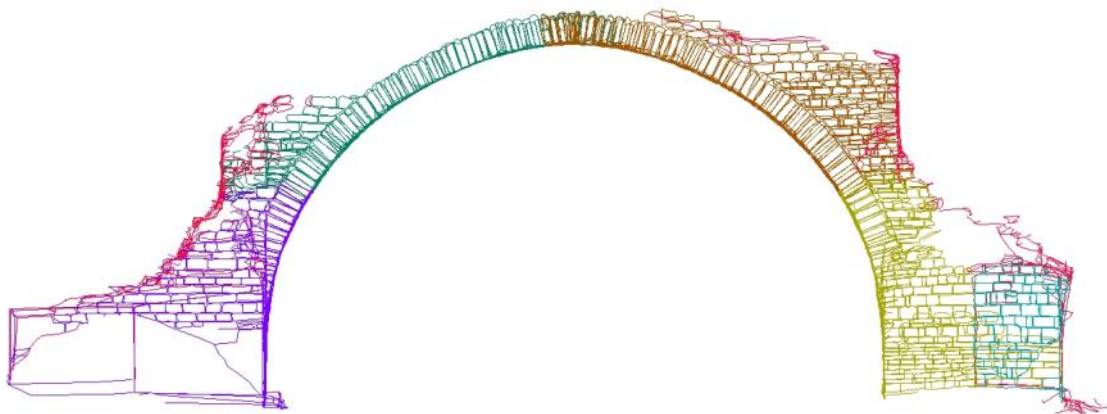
Vista en alzado del despiece del arco de la margen izquierda.
